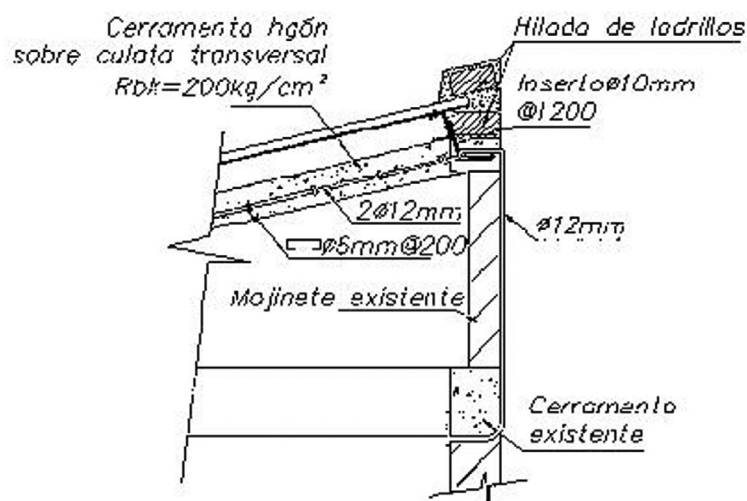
DETALLES DE CINTA DE AMARRE EN VIVIENDA INTERVENIDA.
